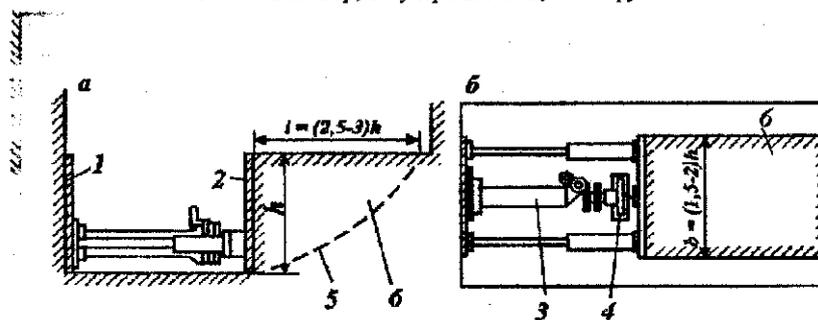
Схема установки в разрезе (а) и в плане (б) для определения испытания грунта на сдвиг вытиранием:
